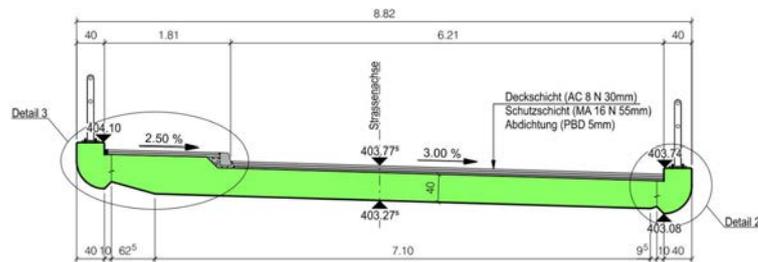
Querprofil der Brücke Werkstrasse, Äächeli
